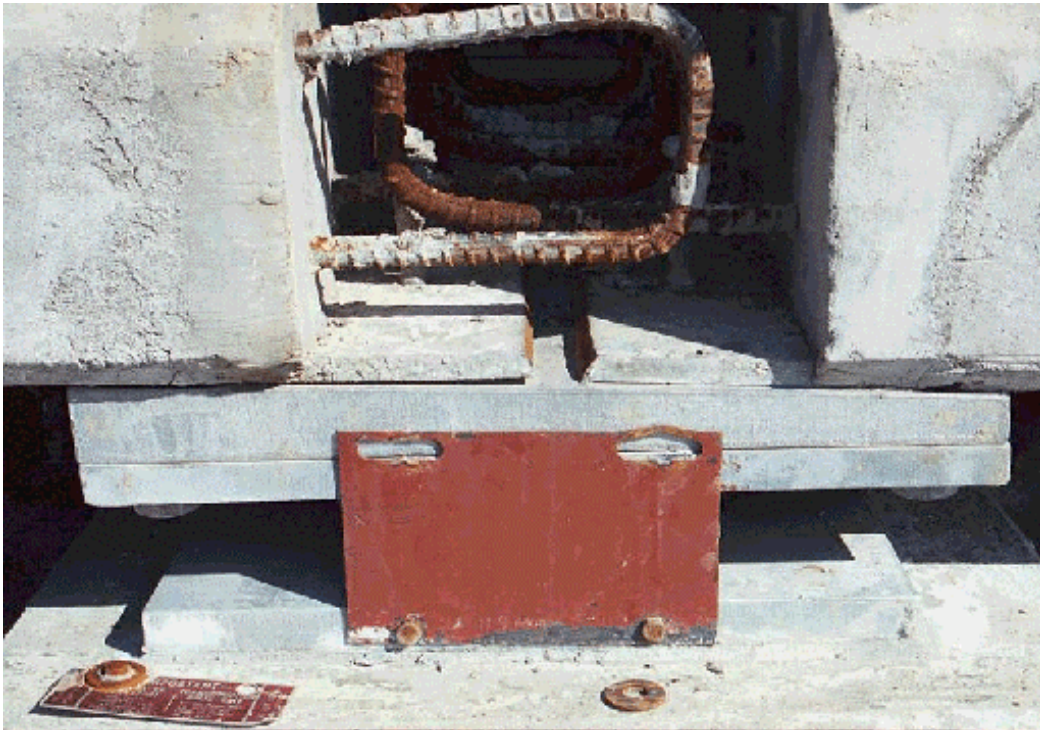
Poutre 5 à la pile 4 (photo 330.8.09)
